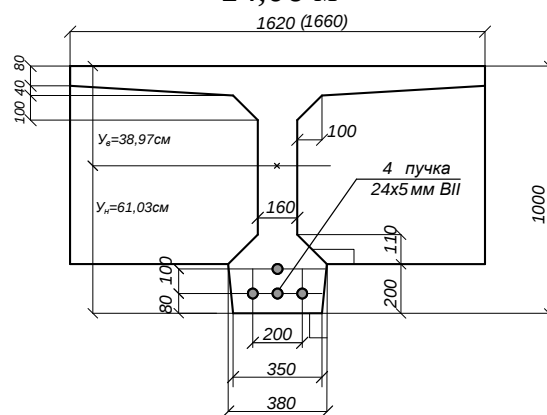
Поперечний переріз середніх балок прогонової будови довжиною 16,76 м
